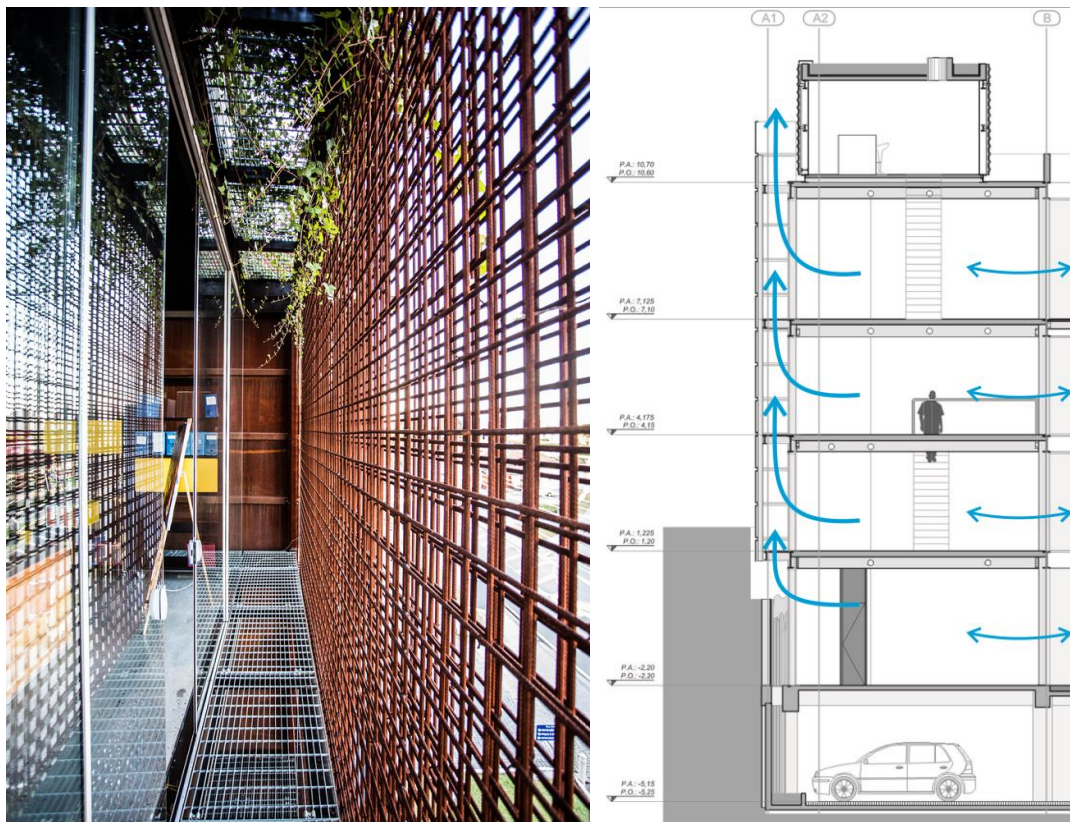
Edifício Oxi – Vista do vão de ventilação.
